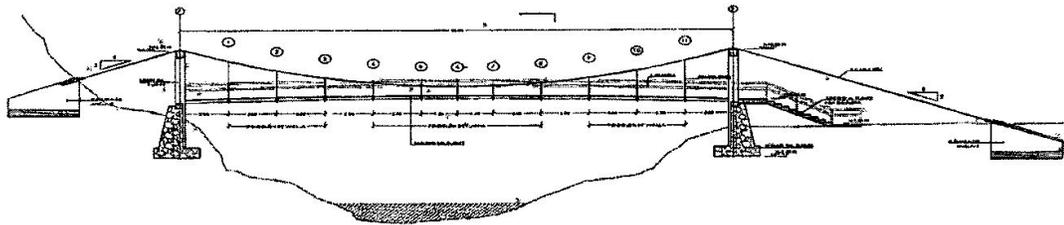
Vista longitudinal del puente colgante peatonal - Quebrada San Francisco⁹
